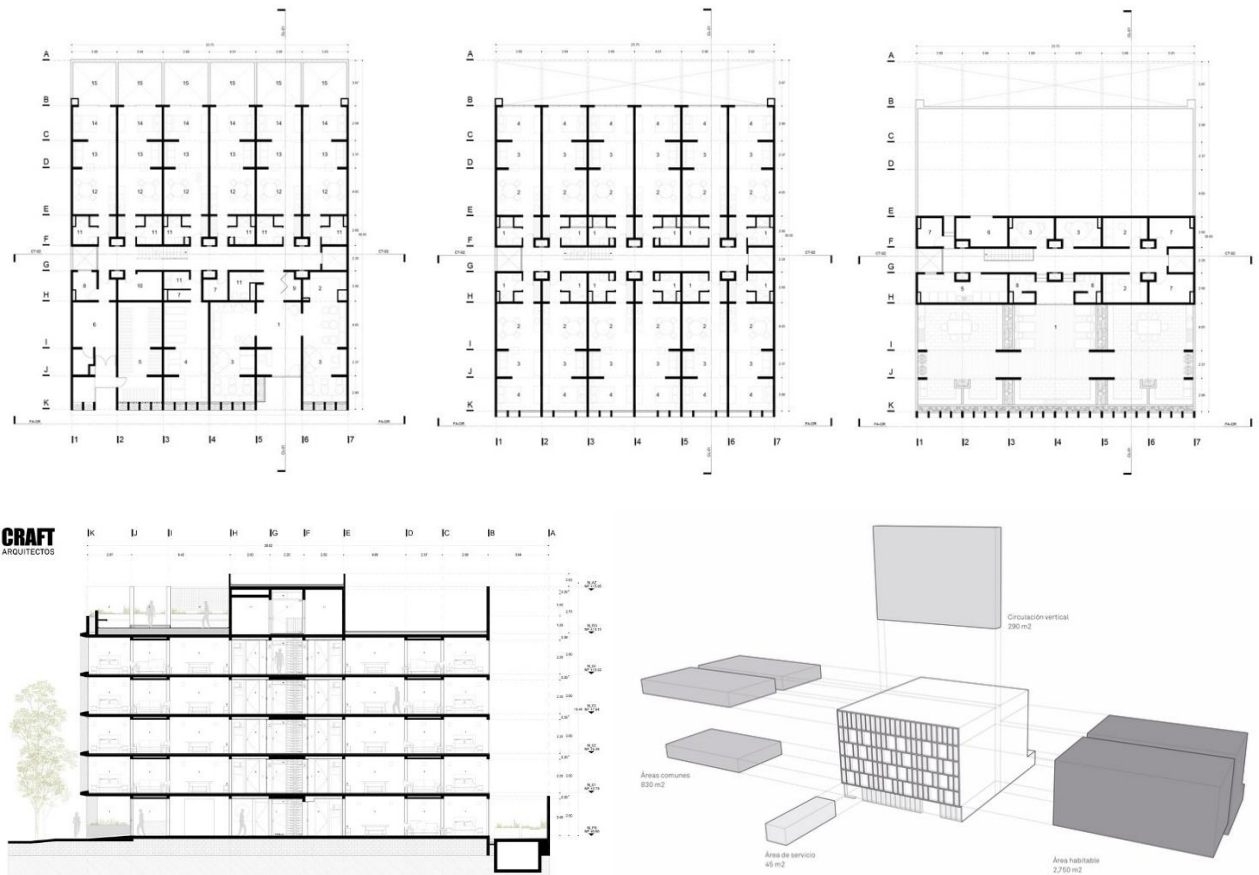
Планувальні рішення, розріз та схема функціонального зонування будівлі [18]
